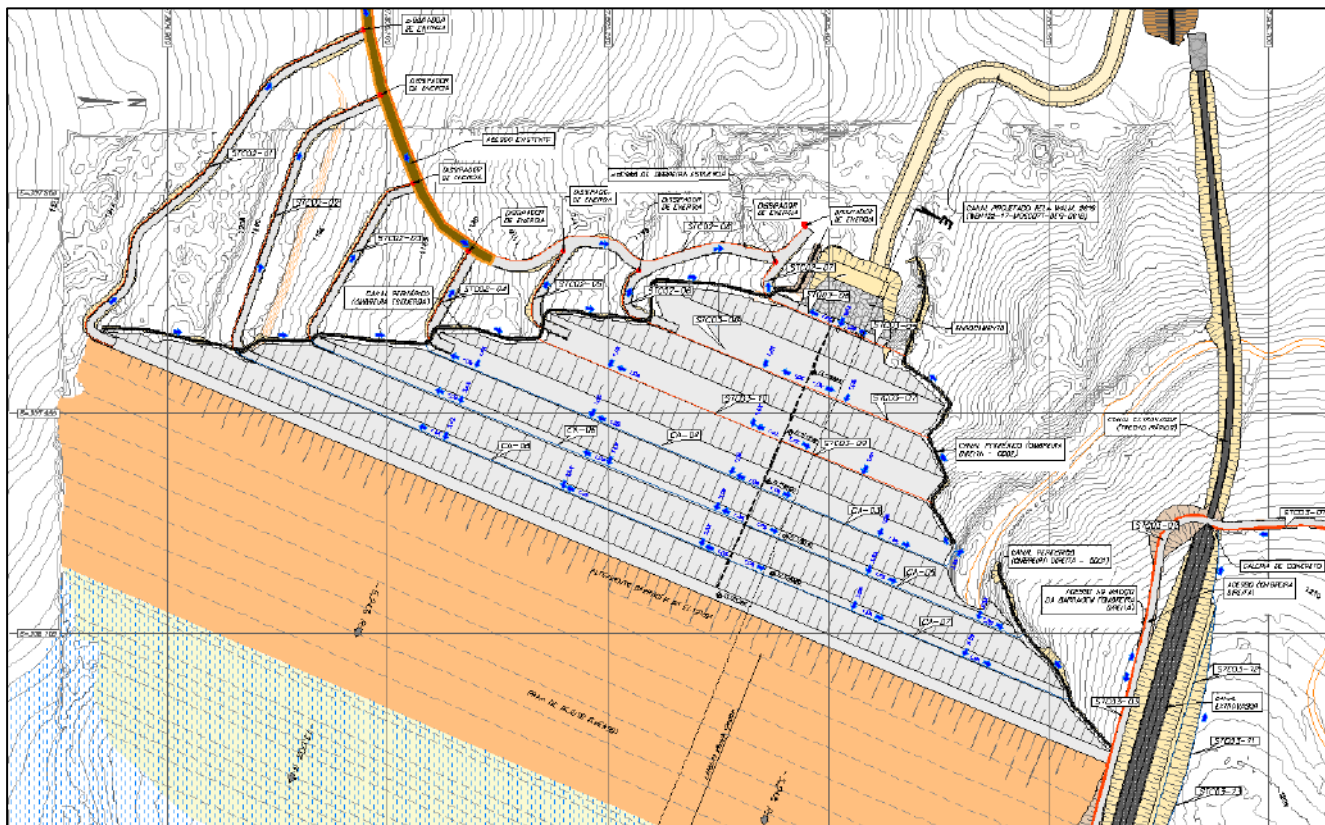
Concepção do sistema de drenagem conceitual para o maciço da Barragem BR após alteamento para elevação 1210,00 m
